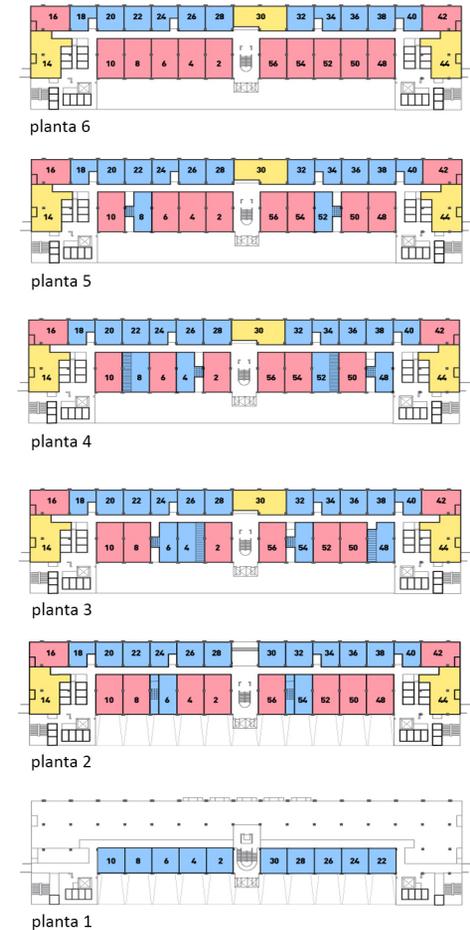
Plantas de distribución de tipología de viviendas, edificio Gerard.
